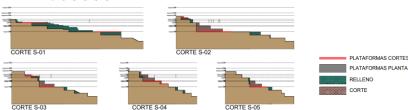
Planta y cortes de plataformas Fuente: Elaboración propia.
